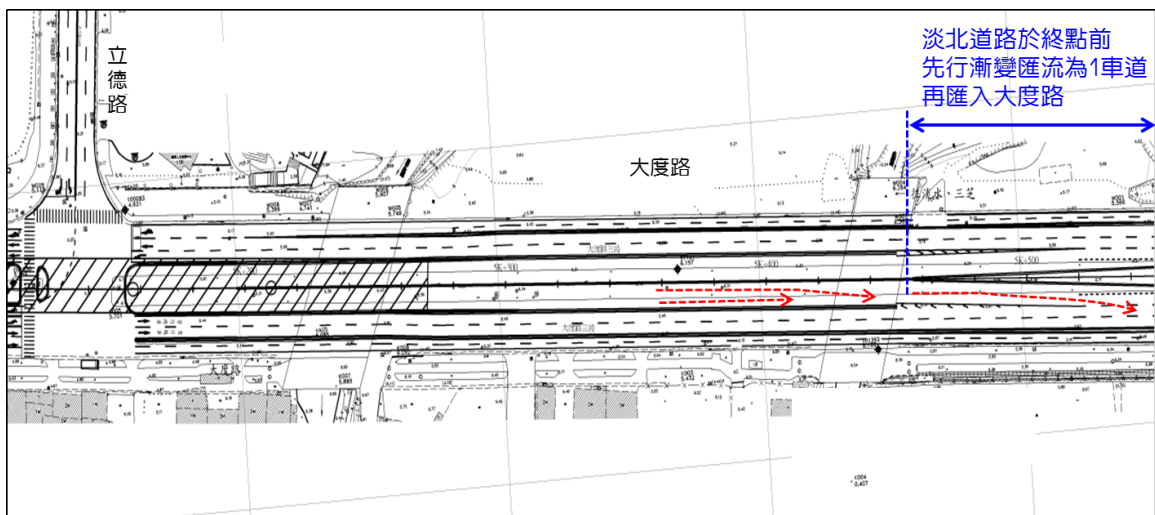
淡北道路台北市端之出口車道配置平面圖
